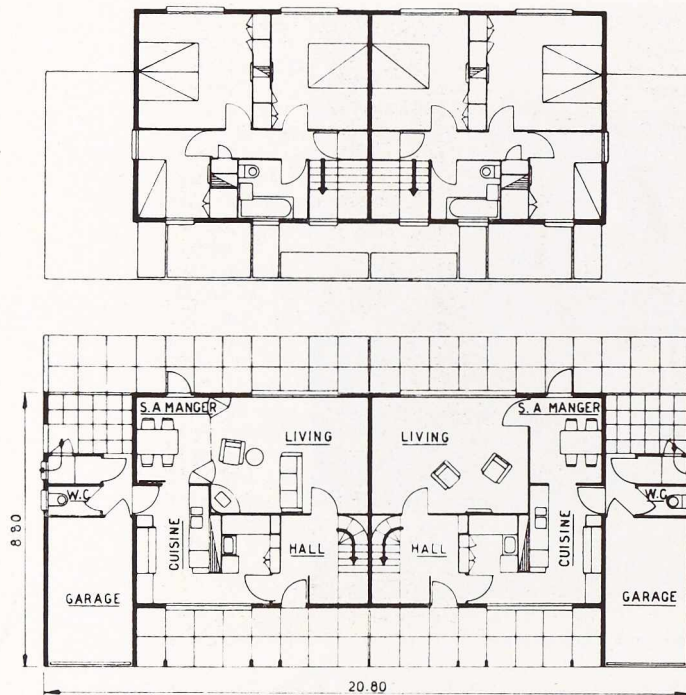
Plans du rez-de-chaussée et du premier étage de la maison « Coventry ».
